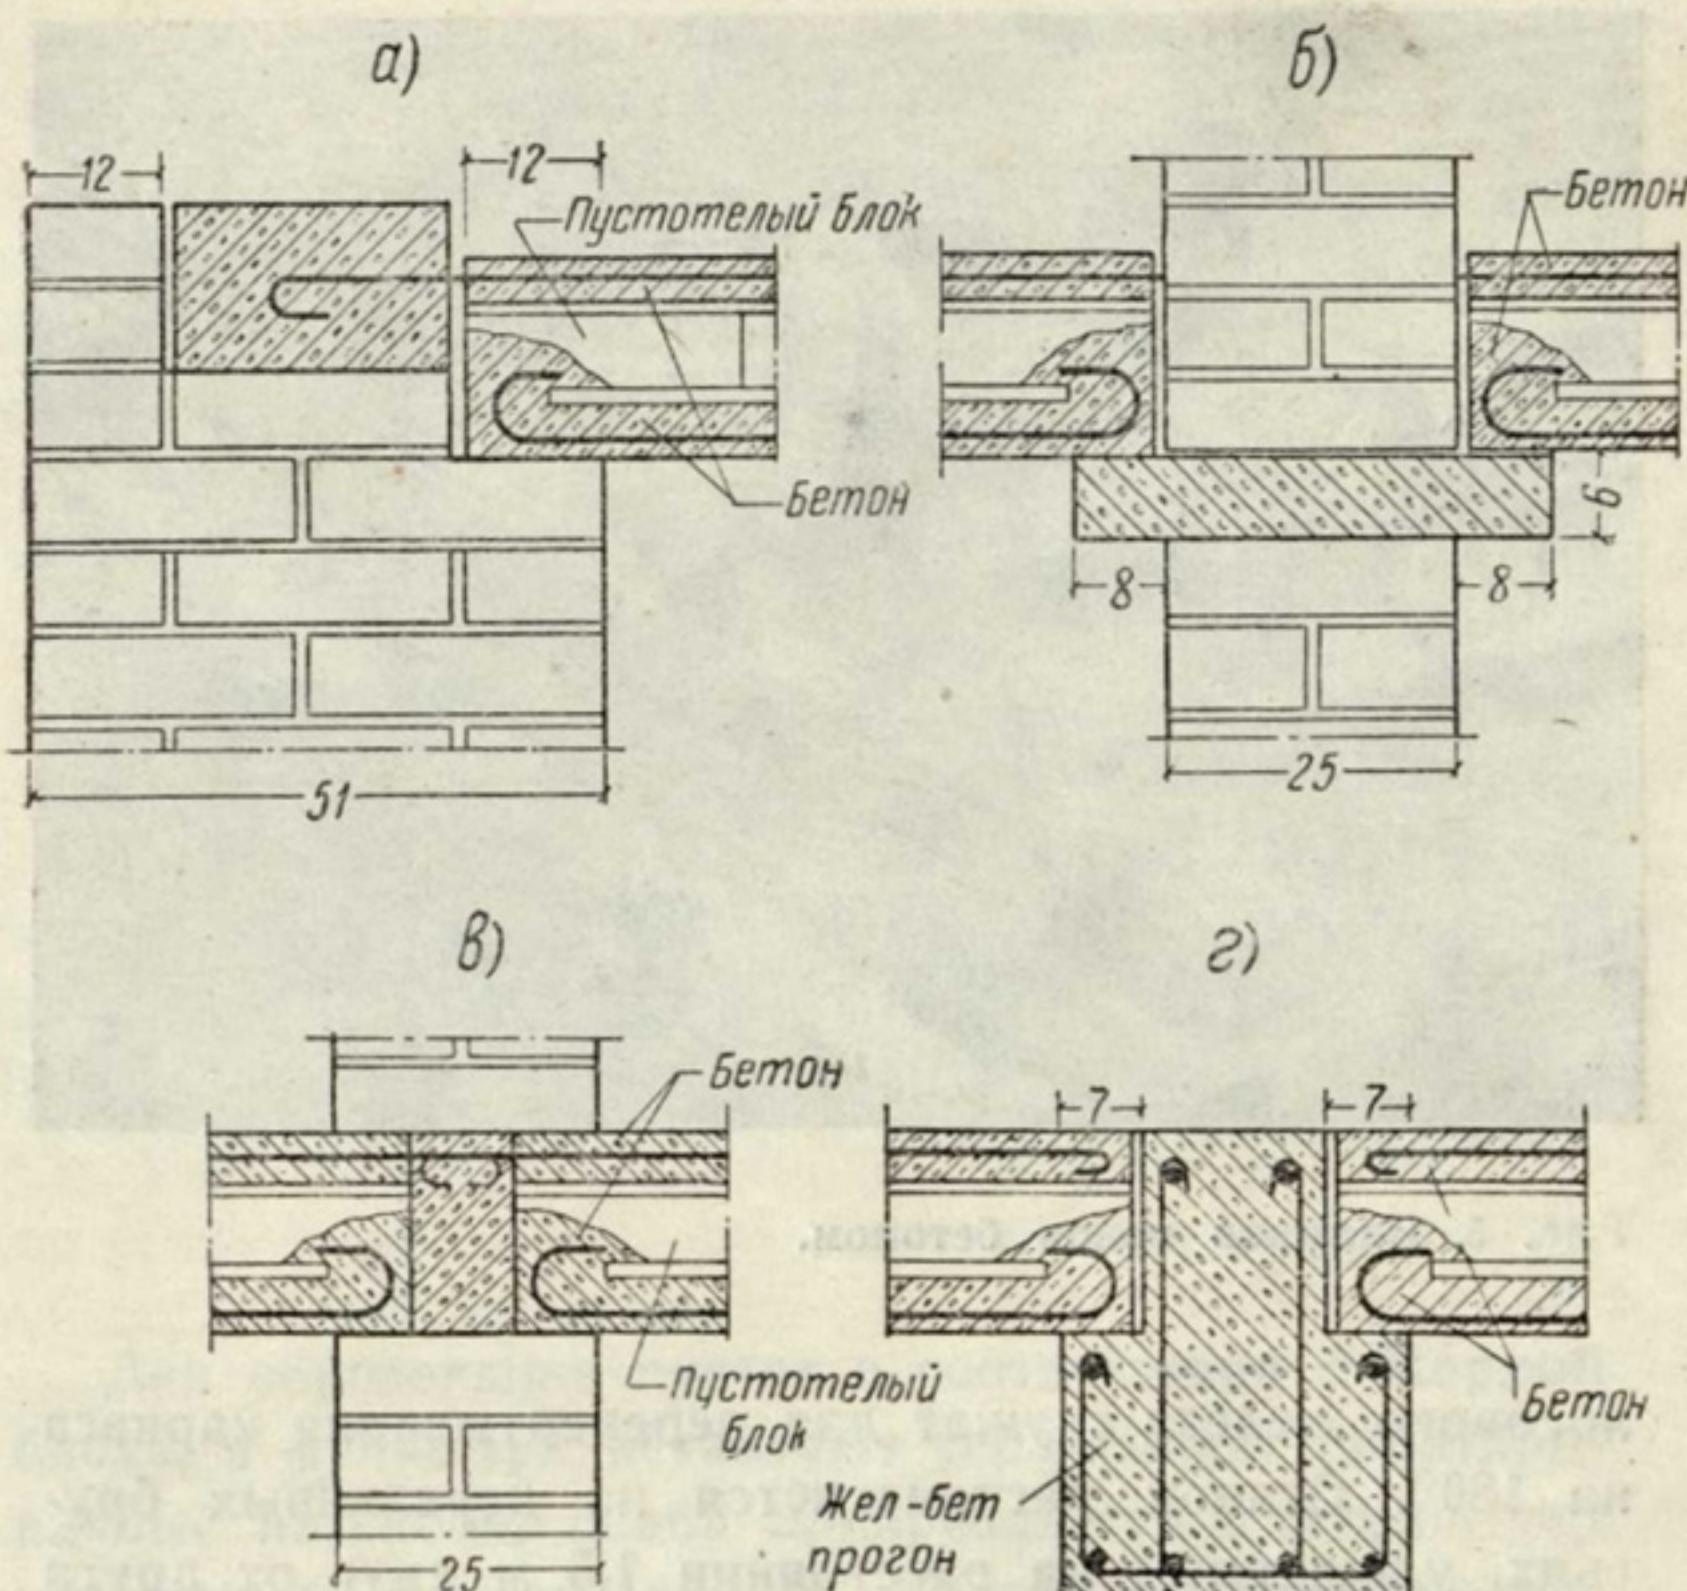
Детали опирания балки: а) на наружную стену, б и в) на стену в один кирпич, г) на железобетонный прогон.
